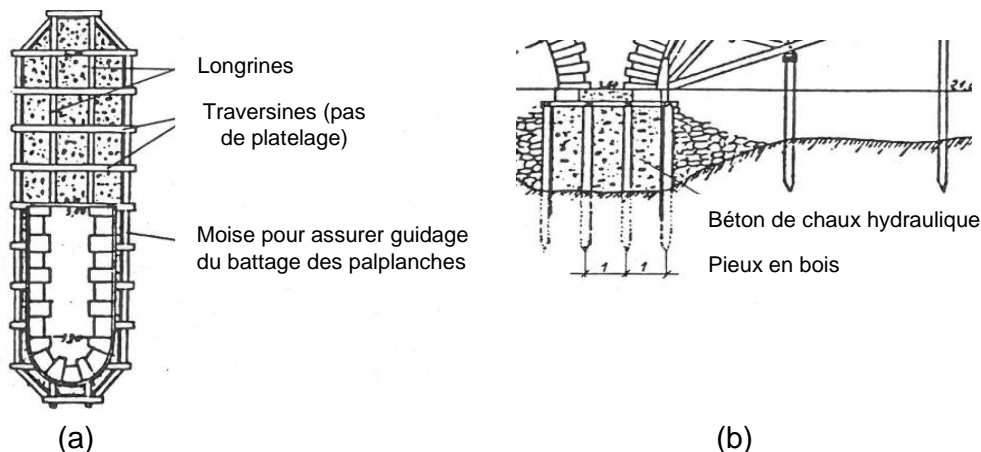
Vues de dessus (a) et de profil (b) des fondations du pont Rousseau construit sur la Loire (modifié d'après [Levillain, 1980](#))
